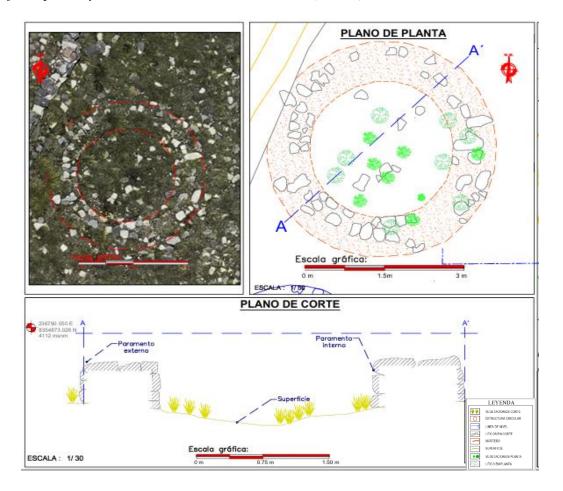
Dibujo de planta y corte de la Estructura domestica (Ed-90)
